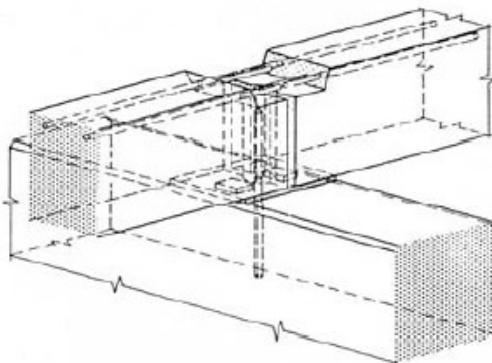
Ligação viga principal – viga secundária através de varões soldados (STUPRÉ, 1981).
